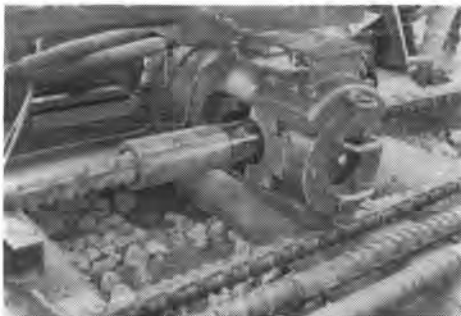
TS式スリーブジョイント機械によるD-51鉄筋の接合状況
